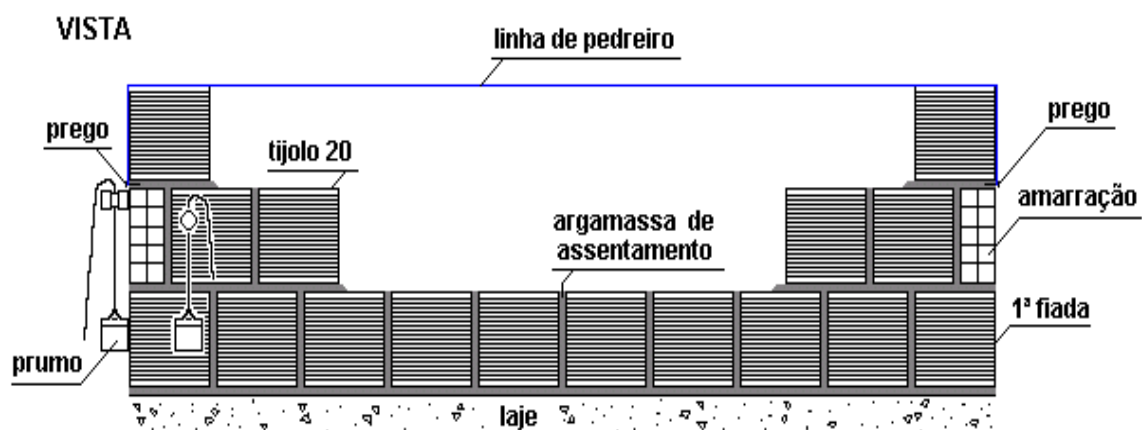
Esquema ilustrativo da construção de uma parede de alvenaria
